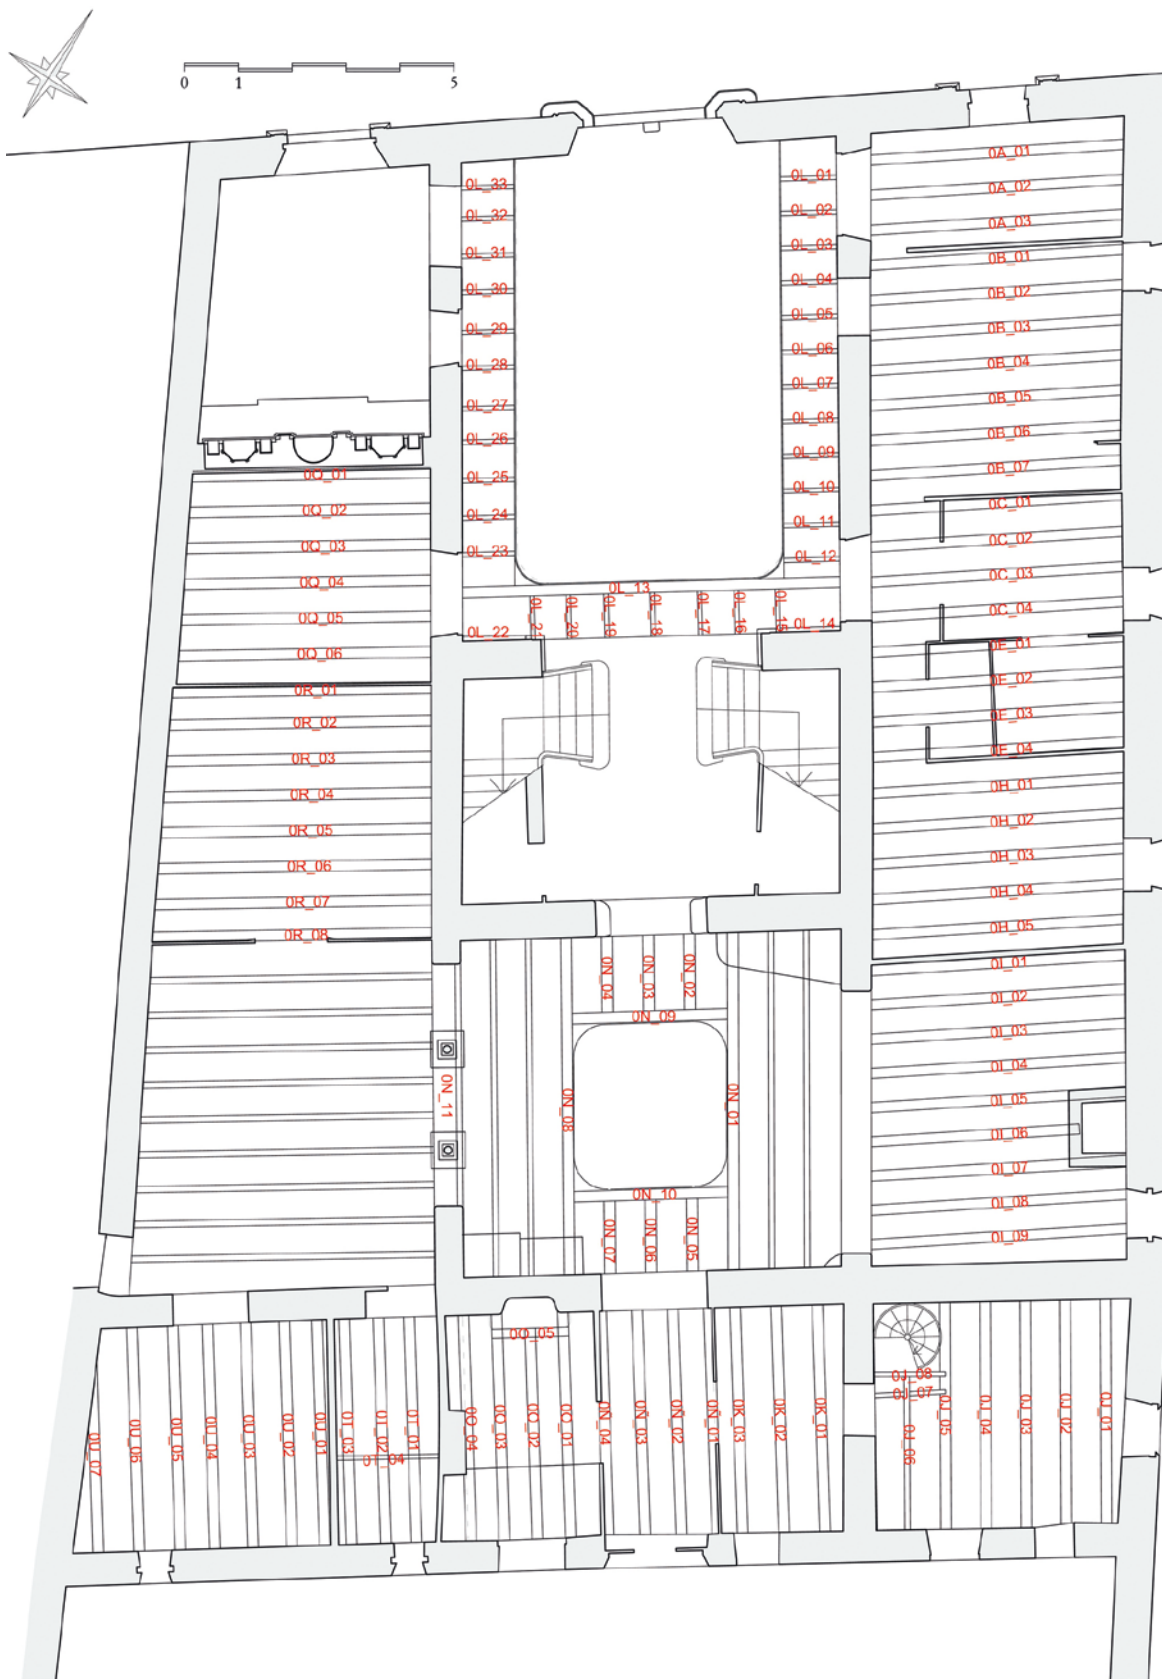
Planta baja del Palacio del Marqués de Benicarló. Códigos de las vigas.
